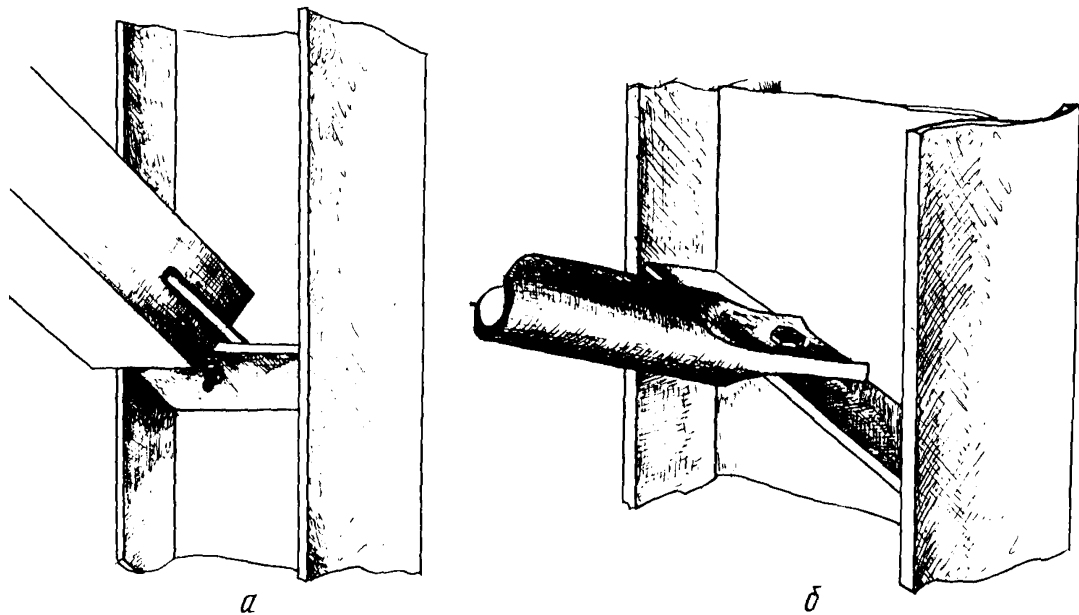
Узлы крепления раскосов в каркасно-панельных зданиях:
